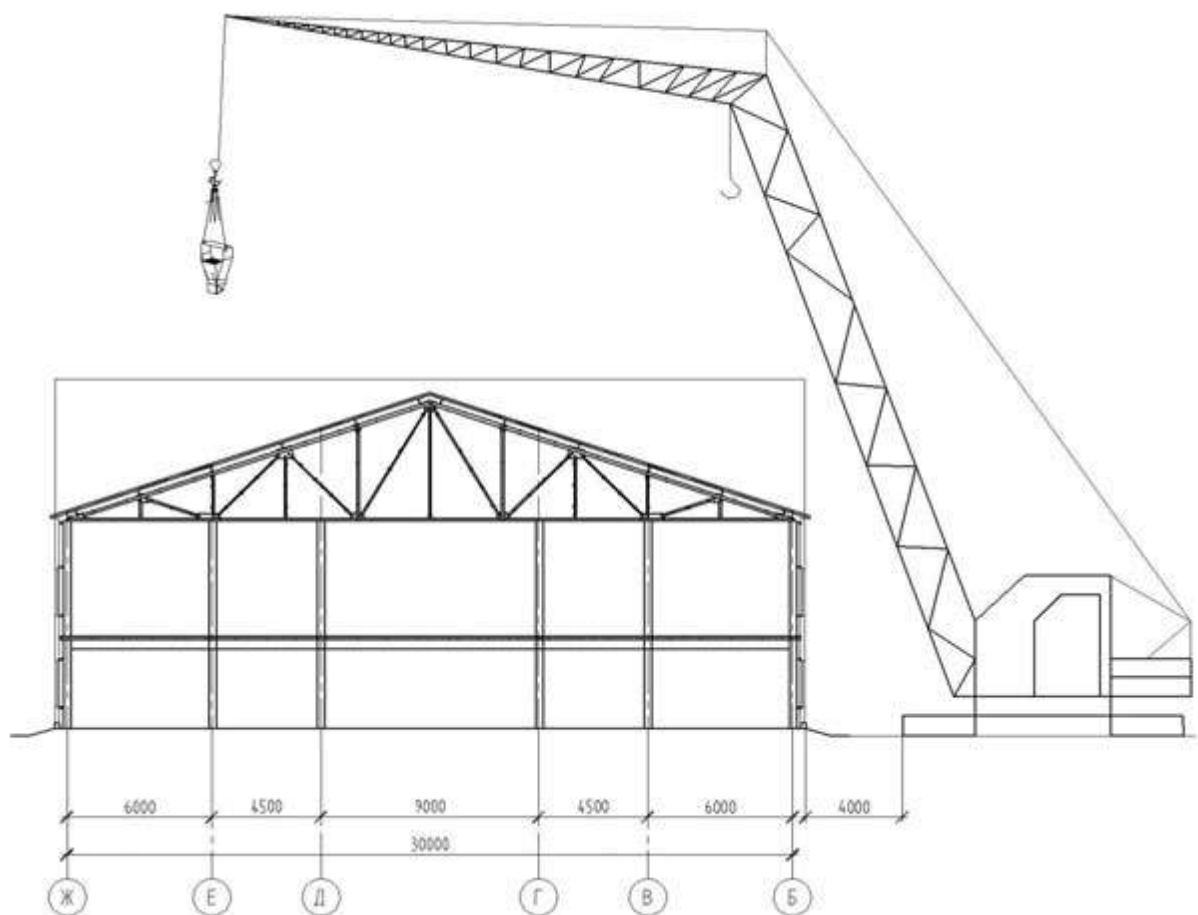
Схема монтажу ферм покриття із застосуванням крана
